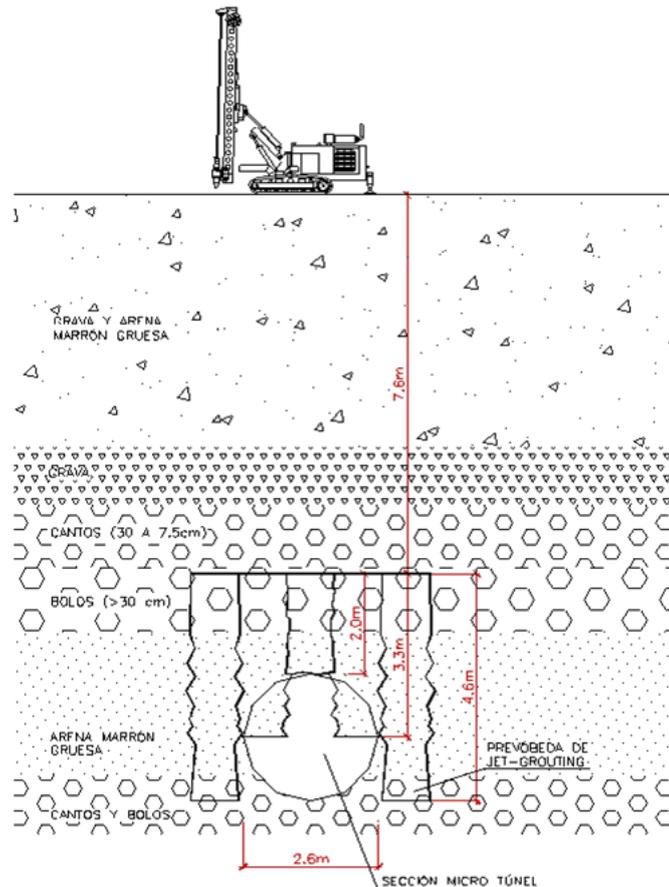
Pre bóveda de jet grouting para la ejecución de un túnel en terreno granular
